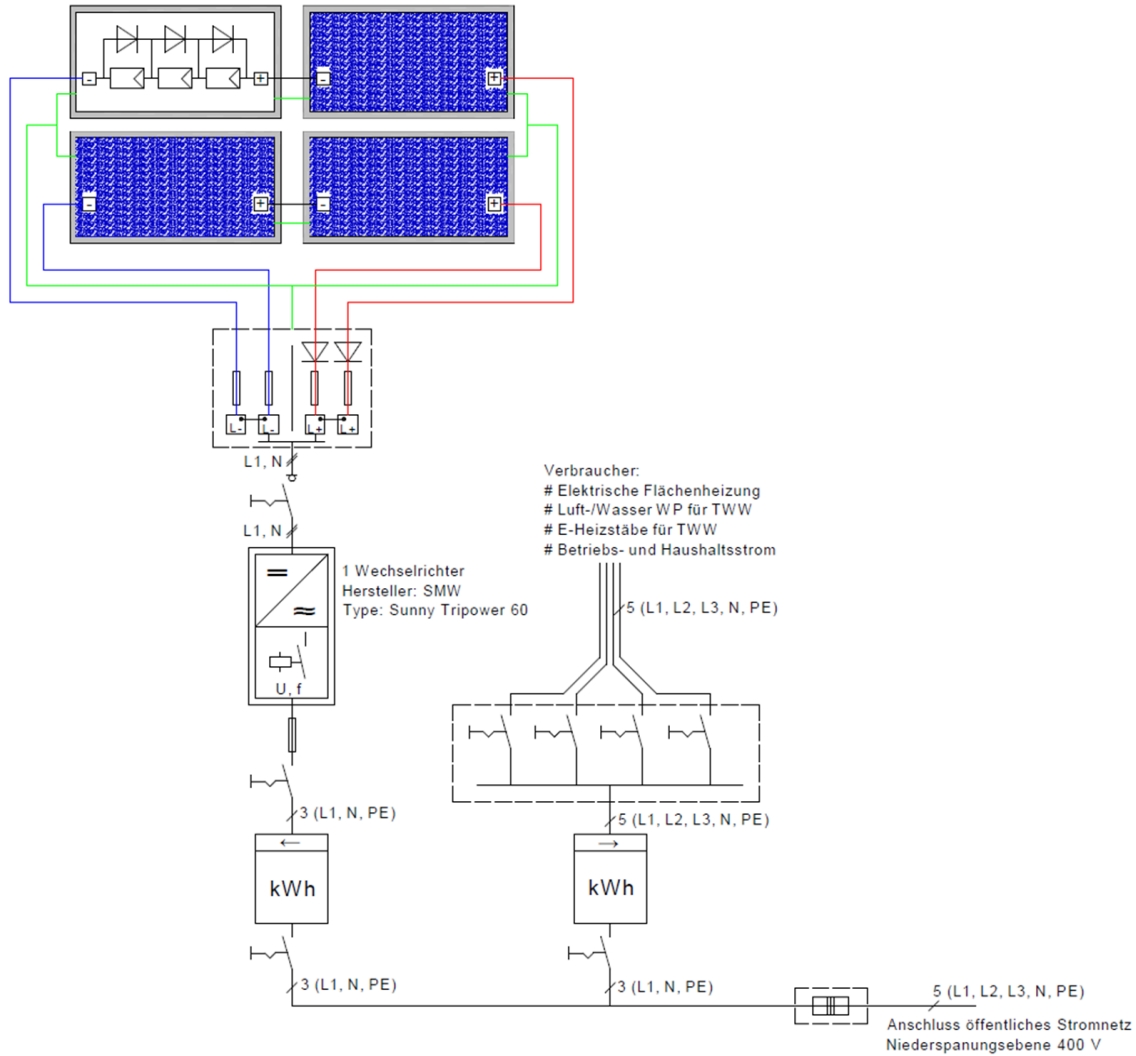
Ausschnitt einer Schemazeichnung zur PV-Anlage (gesamtes Schema im Anhang D)
